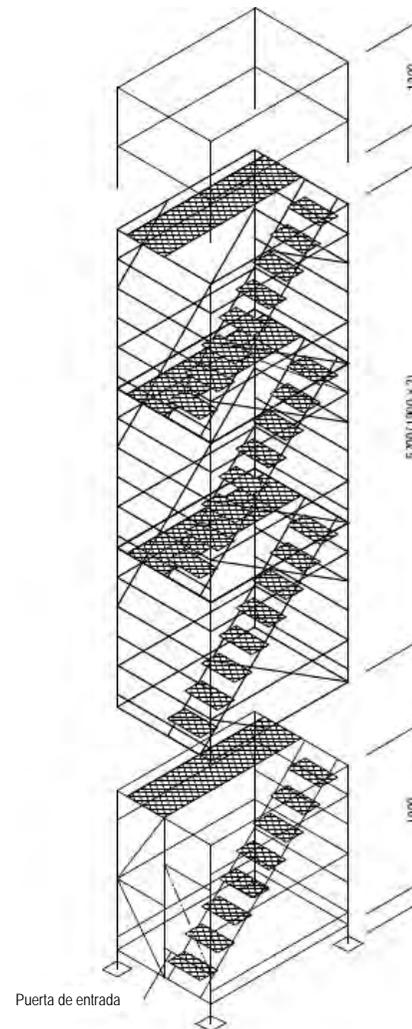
Plano Detallado de la Torre (común para ambas torres de 60m y 30m) (plano referencial)
